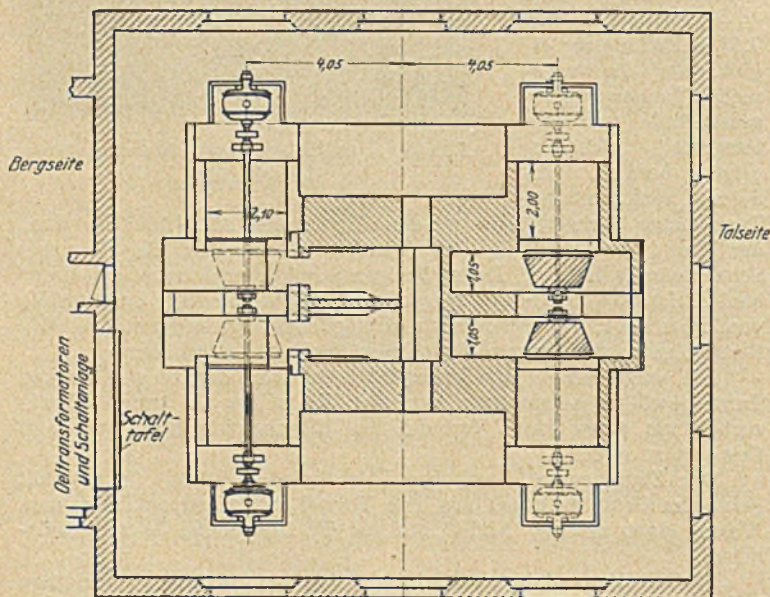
Das Maschinengehäuse. Grundriß zu oben.
